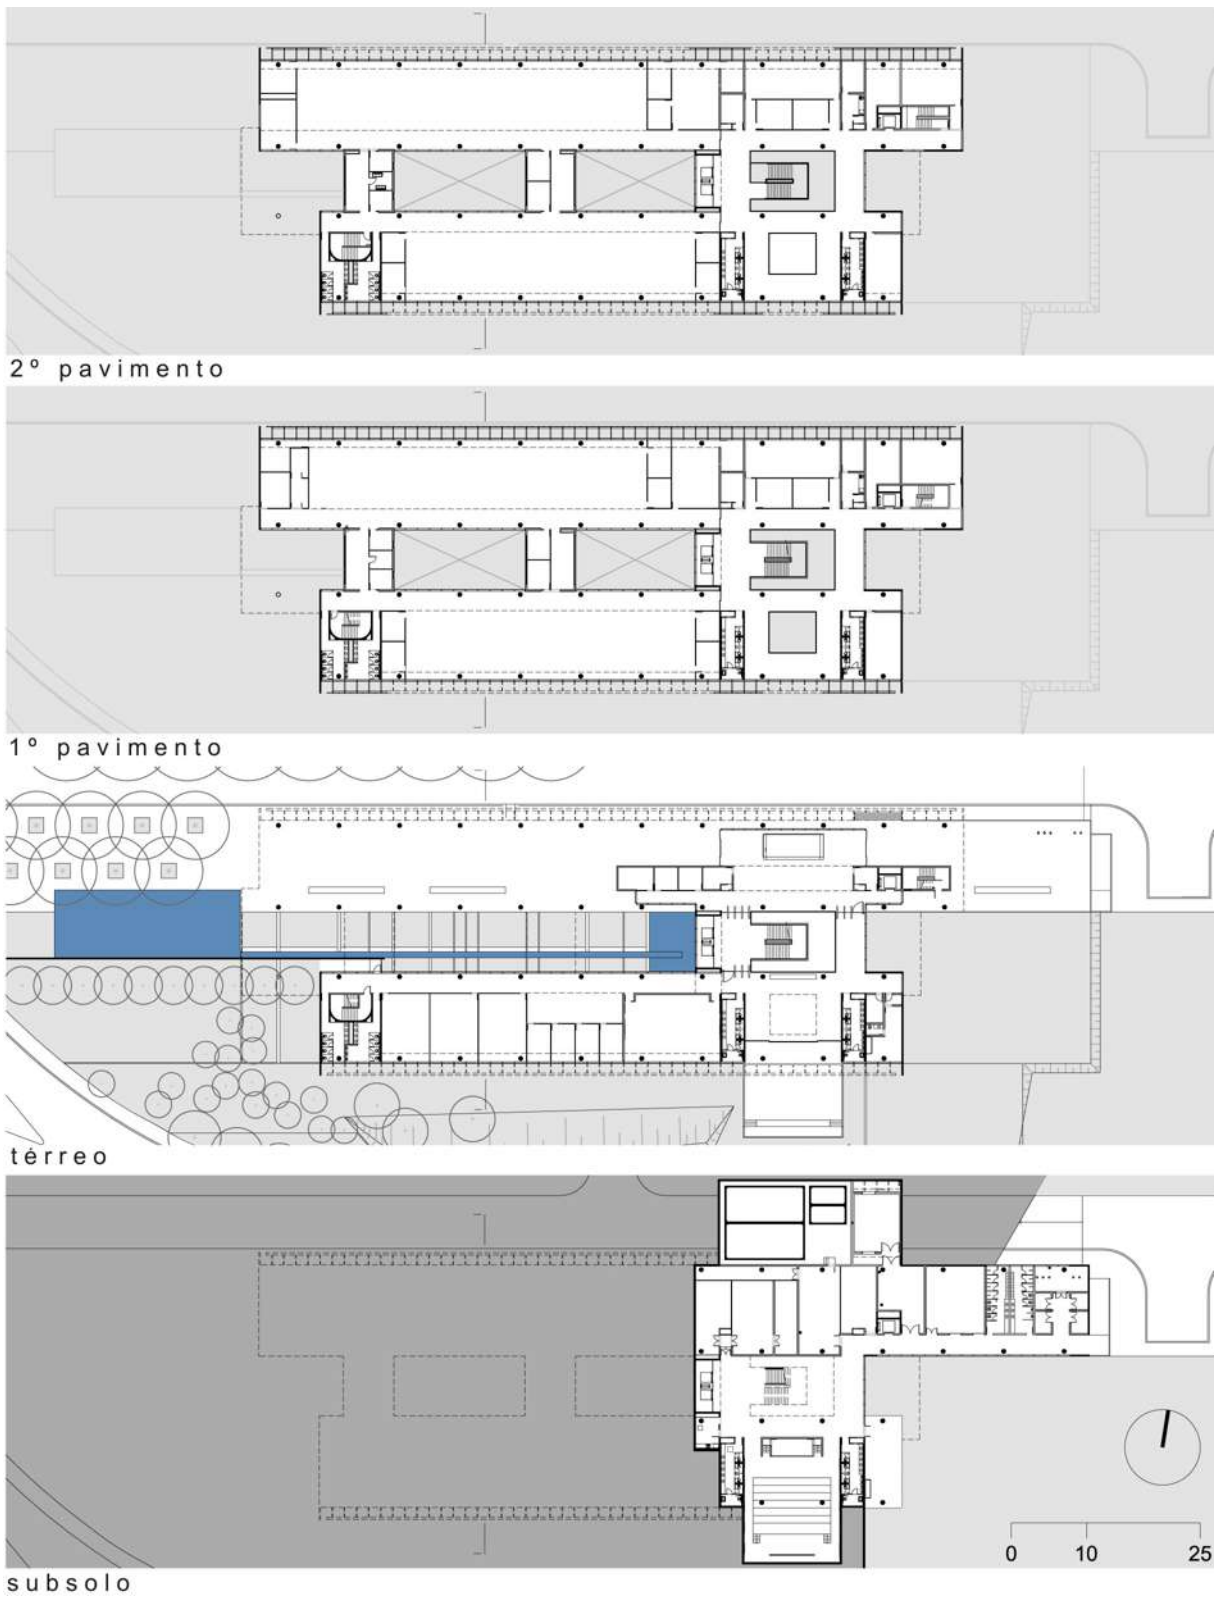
SAP Labs Brazil, plantas dos pavimentos, Documentos de Construção, escala 1/1000 (imagem gentilmente cedida pela Eduardo de Almeida Arquitetos Associados e Estúdio 6 Arquitetos)
